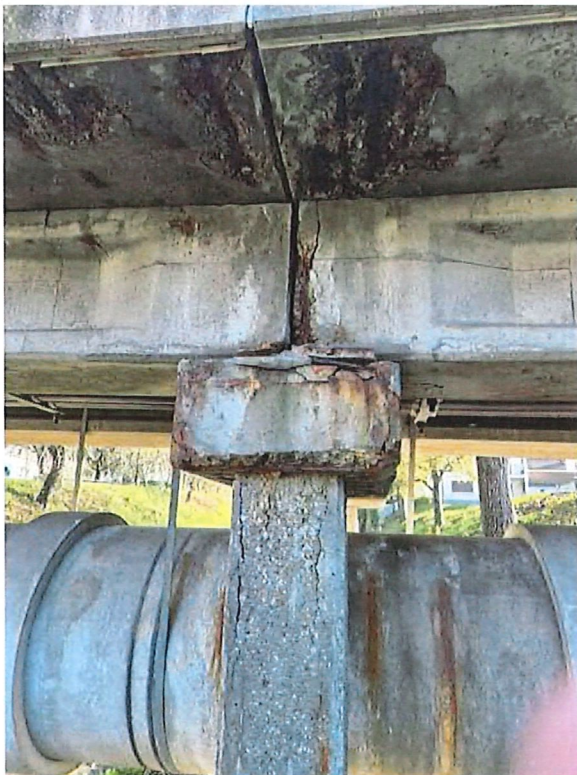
Vista laterale pila Sud con distacchi e ferri corrosi
